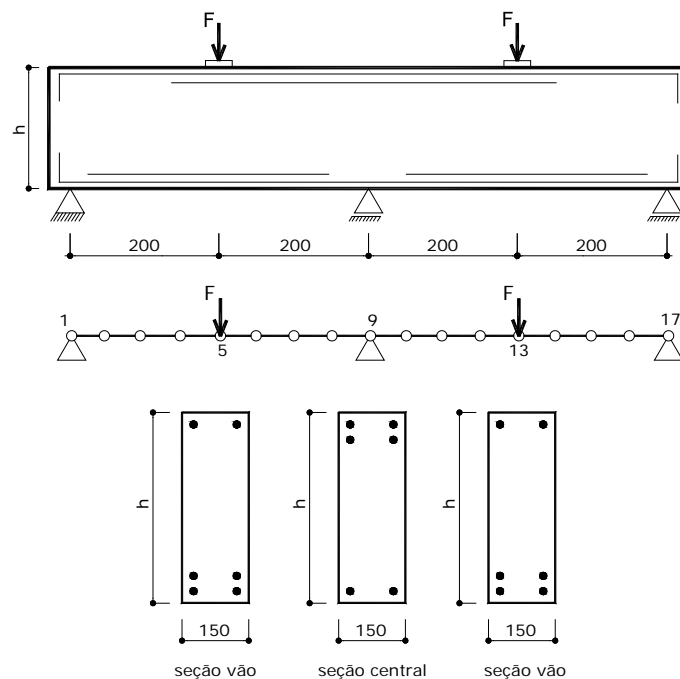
Geometria, detalhamento e discretização da viga em estudo.
